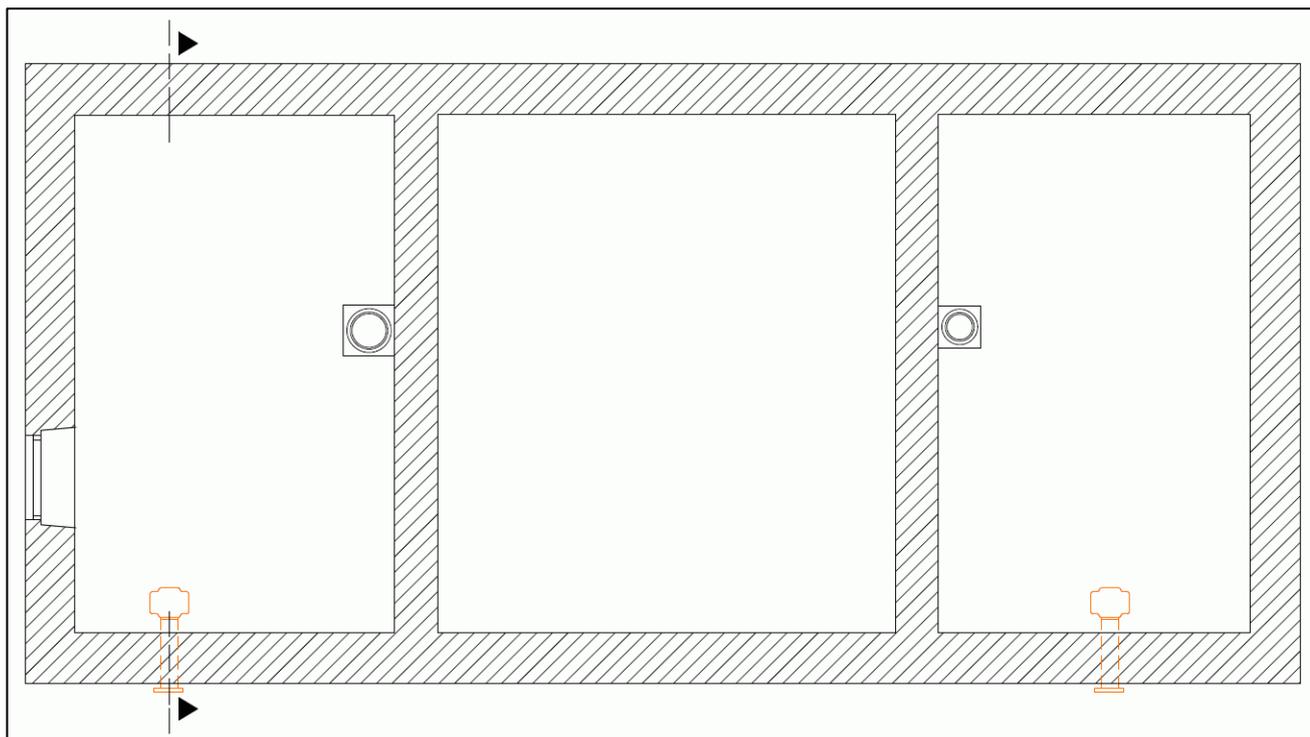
Grundriss, Anordnung der dezentralen Abluftventilatoren
